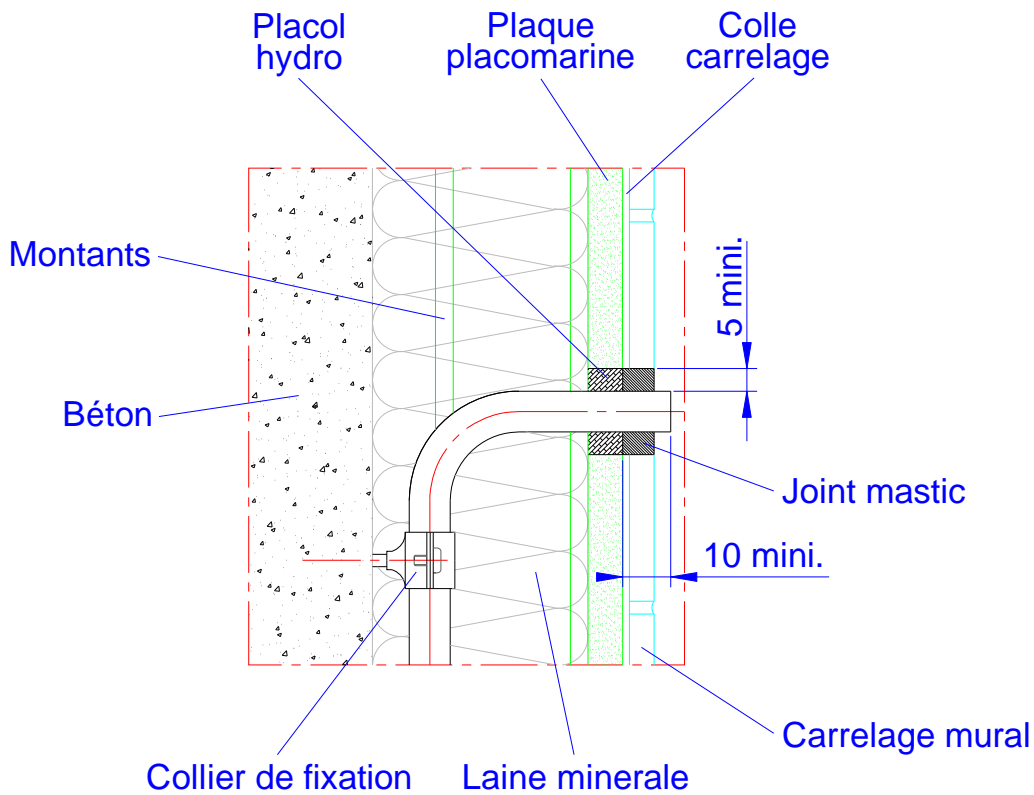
Exemple d'arrivée d'alimentation d'eau au dessus d'un appareil sanitaire, dans un doublage - local EB+ Privatif – coupe verticale
